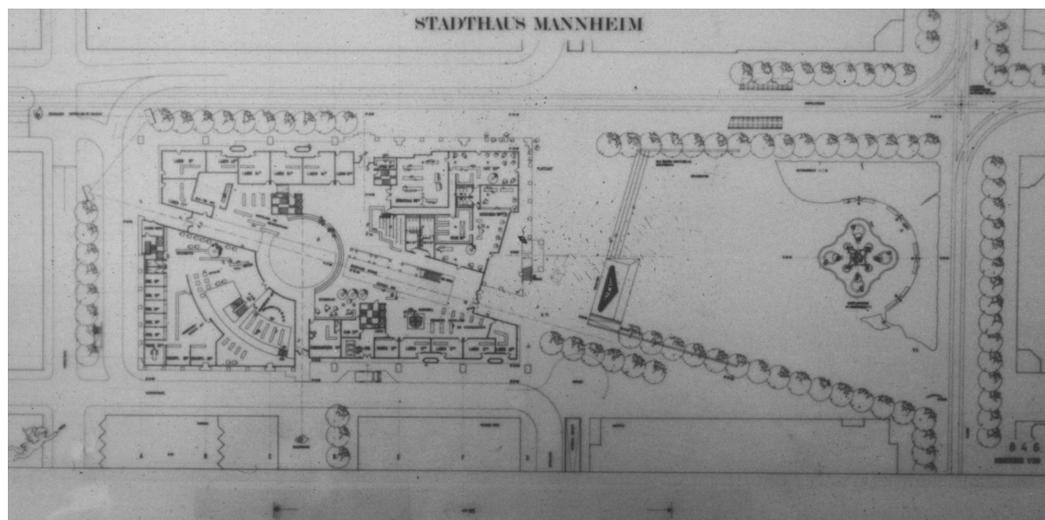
A.P.B., Erdgeschoßgrundriß mit Paradeplatzgestaltung
